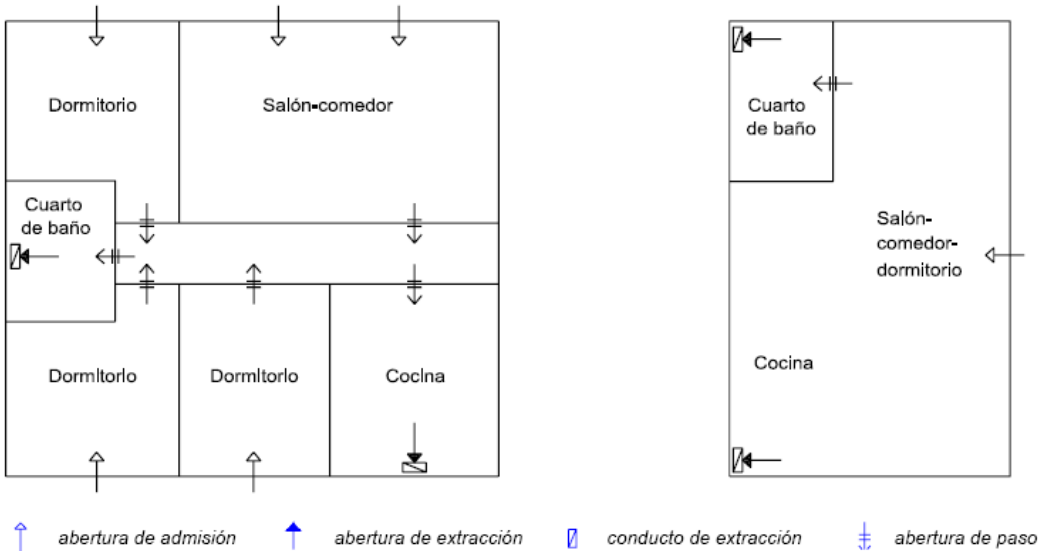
Ejemplos de ventilación en el interior de las viviendas
